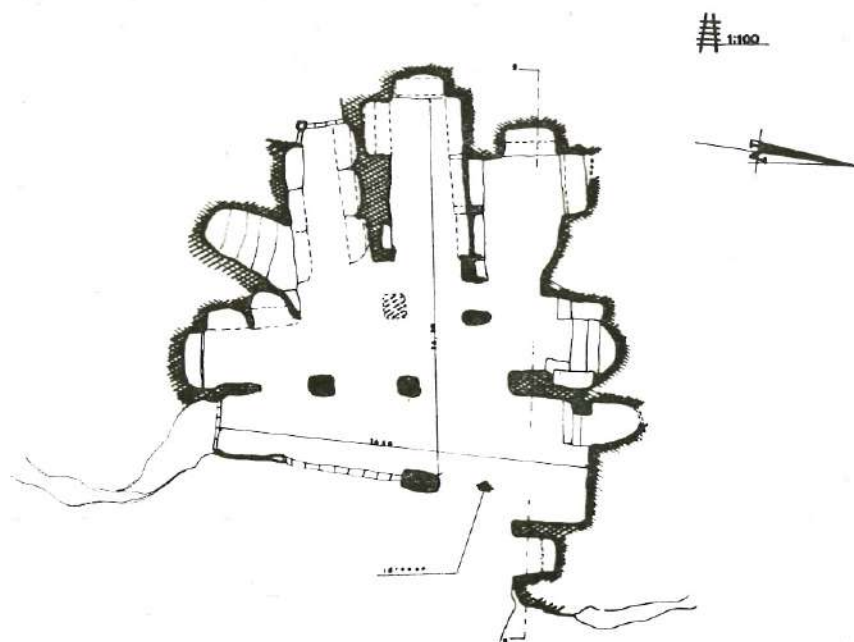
CAPPARELLI: planimetria dell'ipogeo n. 2.
